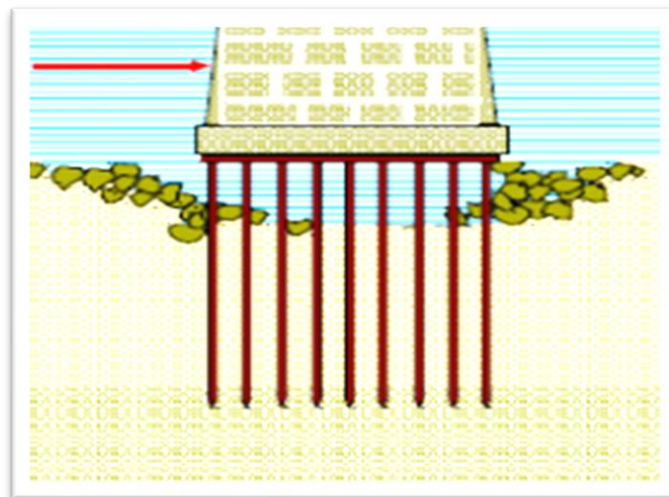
Phénomène d'affouillement du sol autour d'une fondation profonde de la pile d'un pont (Boutaraa, Z. (2019))
